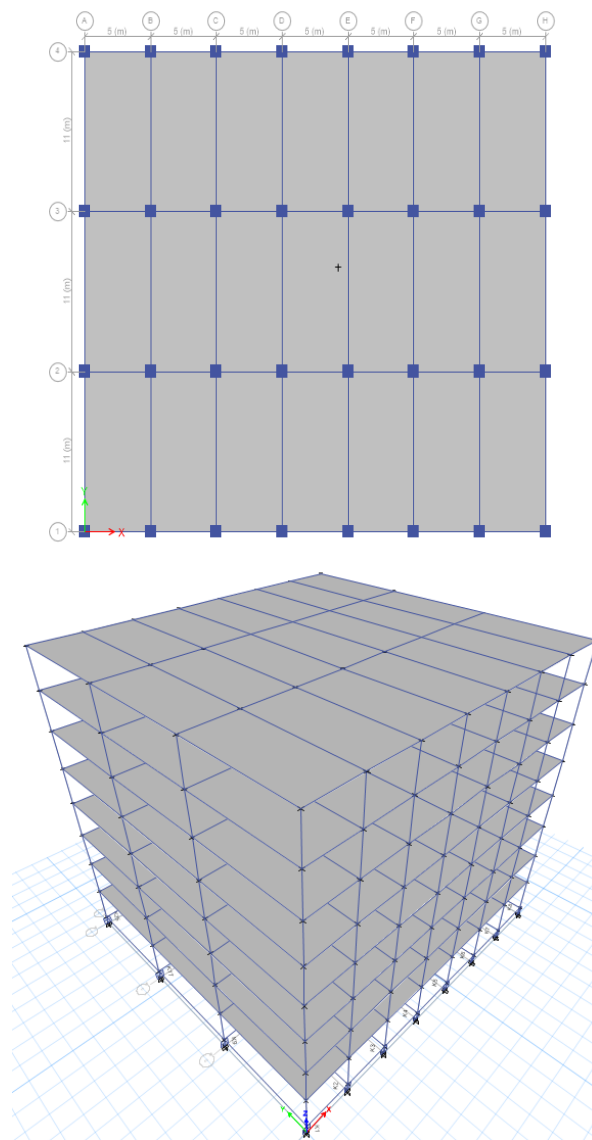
Vista en planta y 3D del modelo estructural cuadrado.
